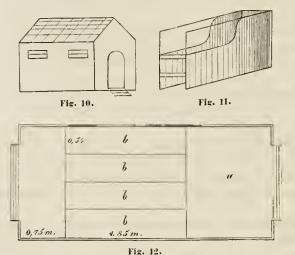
Kälberstall, äussere Ansicht. - Fig. 11. Kälberstand, zum grössten Theile mit Zinkblech bekleidet. - Fig. 12. Grundriss des Kälberstalles.
